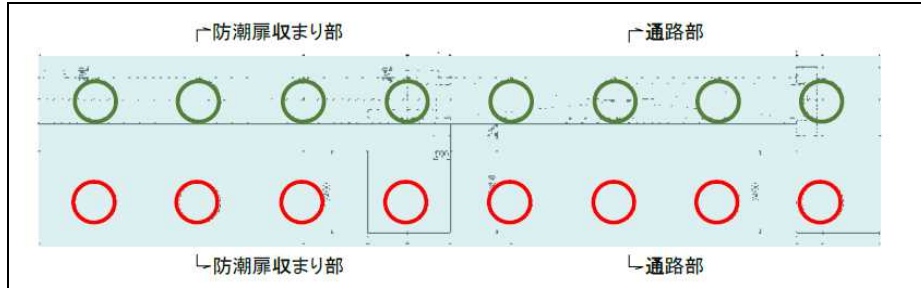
防潮扉平面図 (関西電力 高浜 3, 4 号炉)
